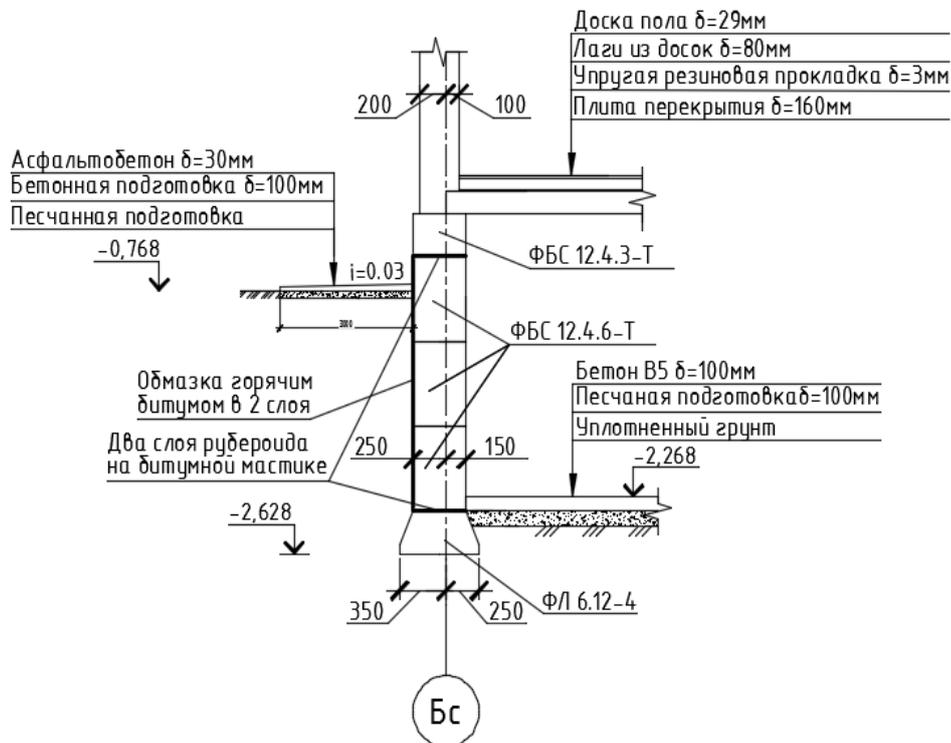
Гидроизоляция фундамента под наружную несущую стену
